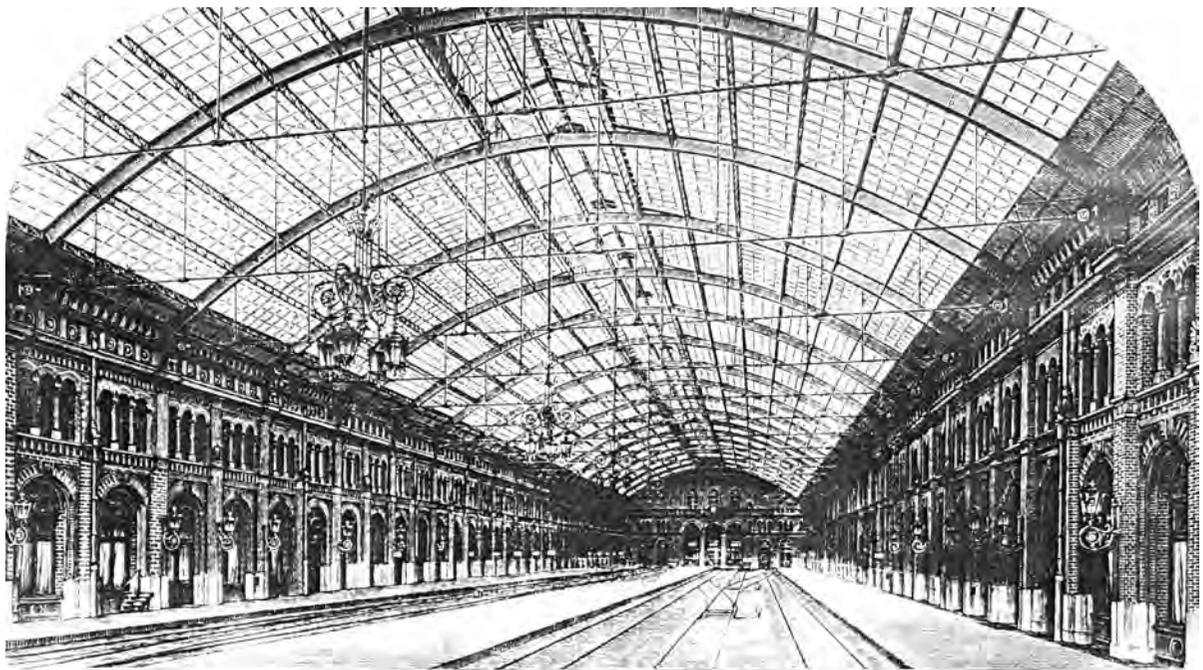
Berlin, Potsdamer Bahnhof, Bahnsteighalle erbaut 1869 – 1871, Bögen aus Blechkasten mit Zugband und Verglasung des Daches (Zeichnung 1876)
